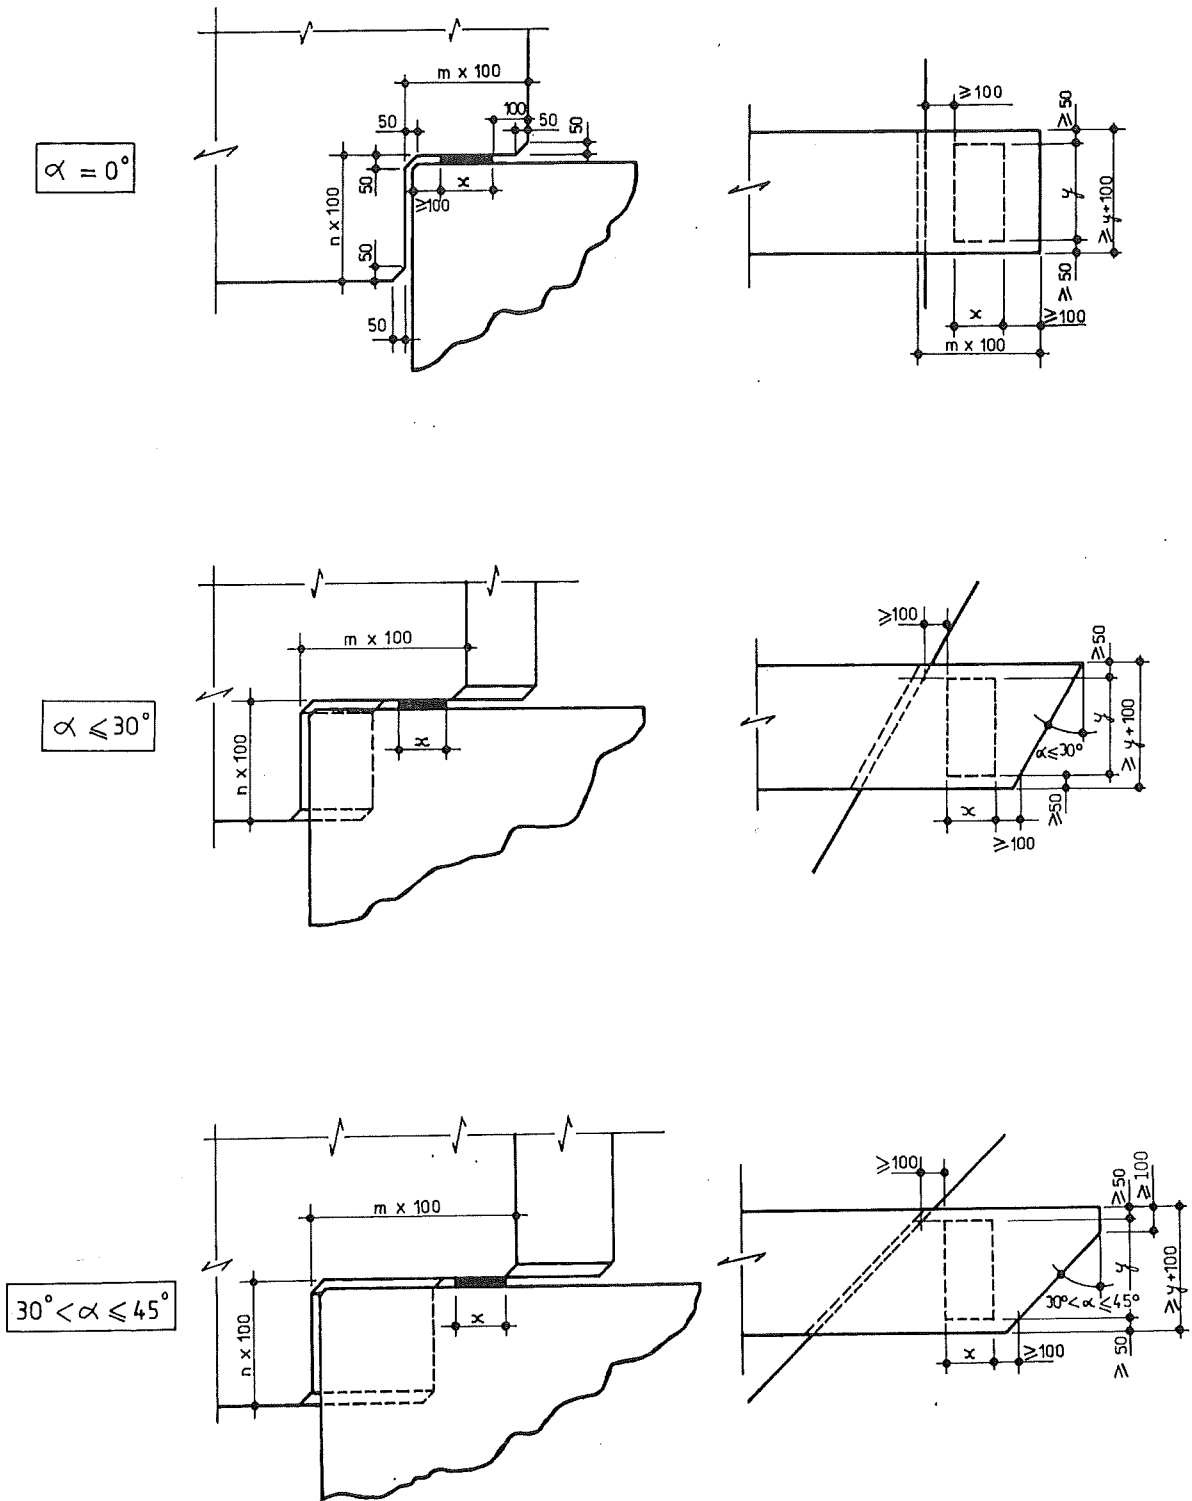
Dimensionnement de la découpe et de l'appui des blocs d'about avec découpe. (dimensions en mm)
